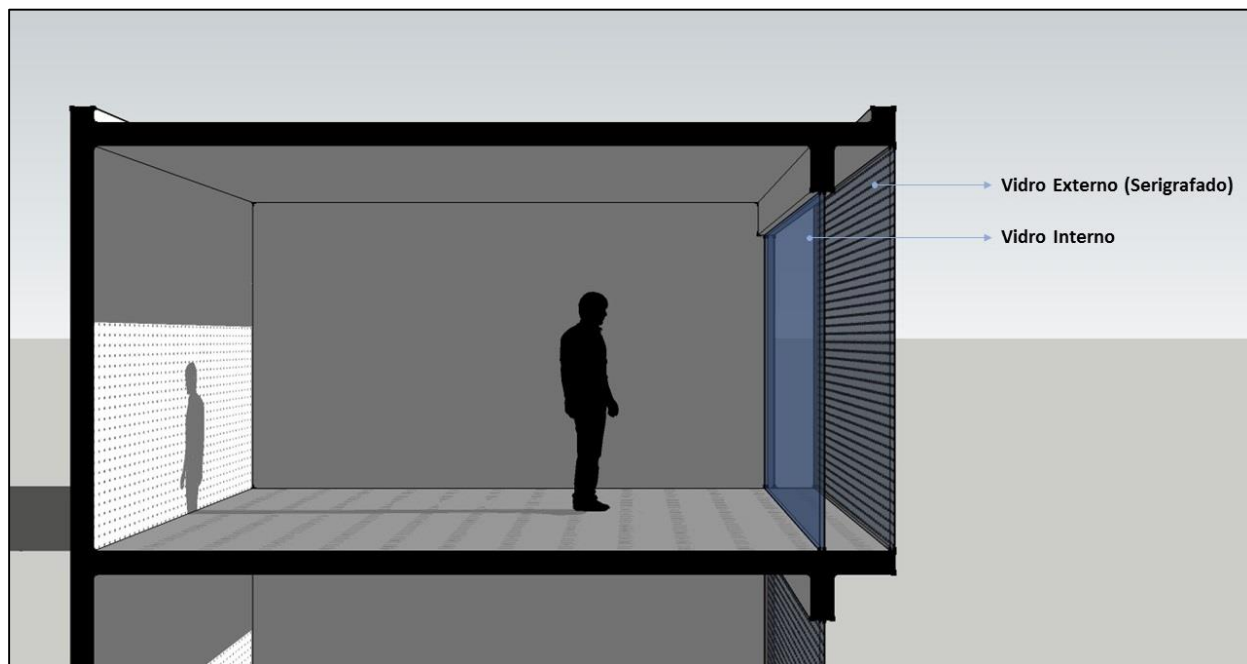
Vidro serigrafado como segunda pele em fachadas duplas ventiladas.
